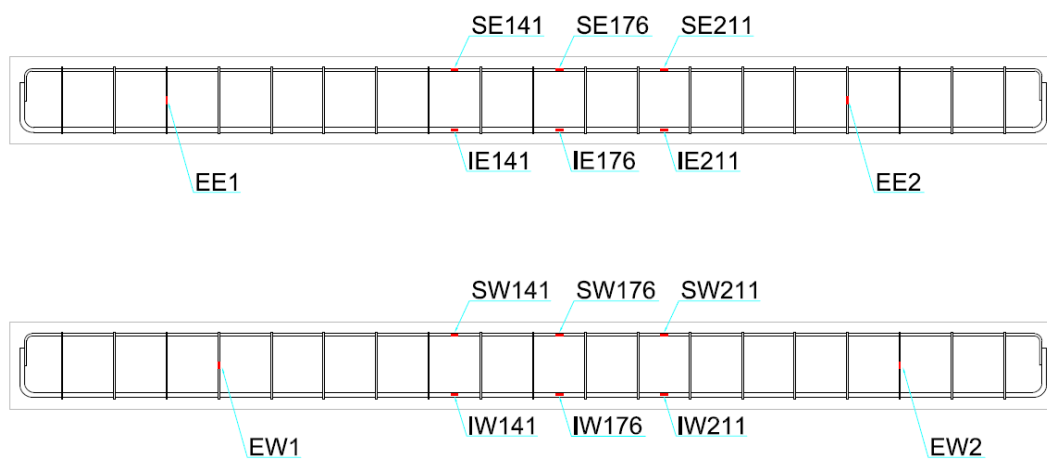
Disposición de las galgas en la armadura para las vigas H50 (*lado Este en la imagen superior y Oeste en la inferior*). Fase Vigas I
